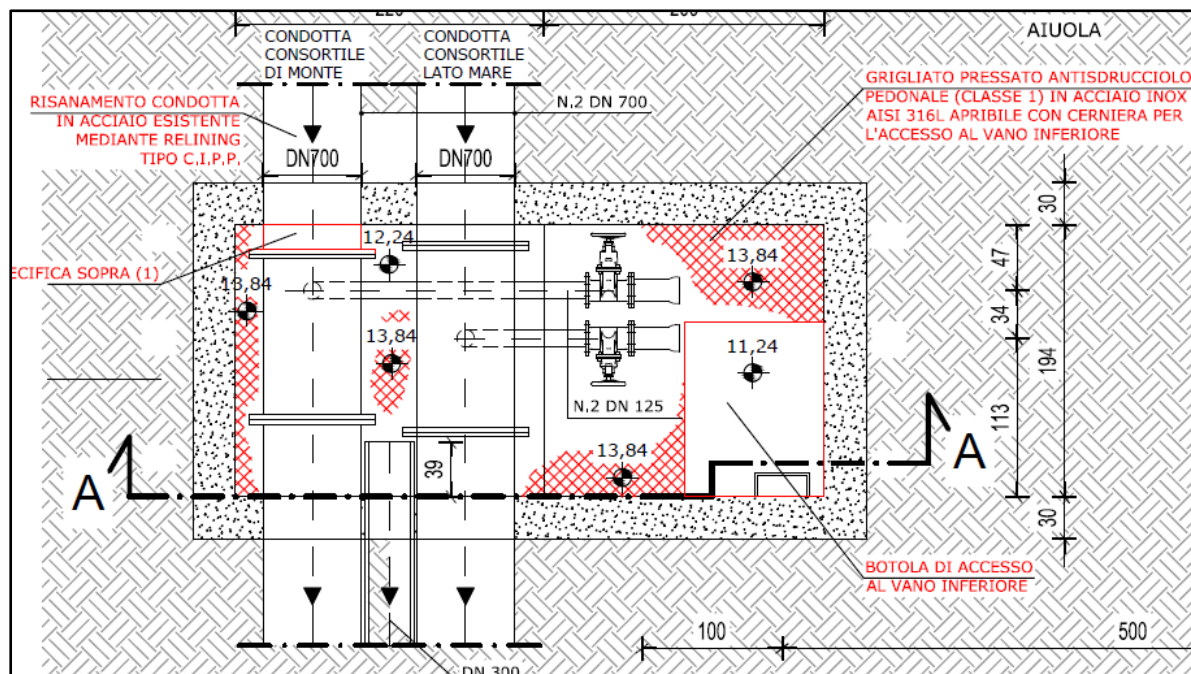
Stralcio della planimetria di progetto degli interventi sulla pozzetto AC di scarico
